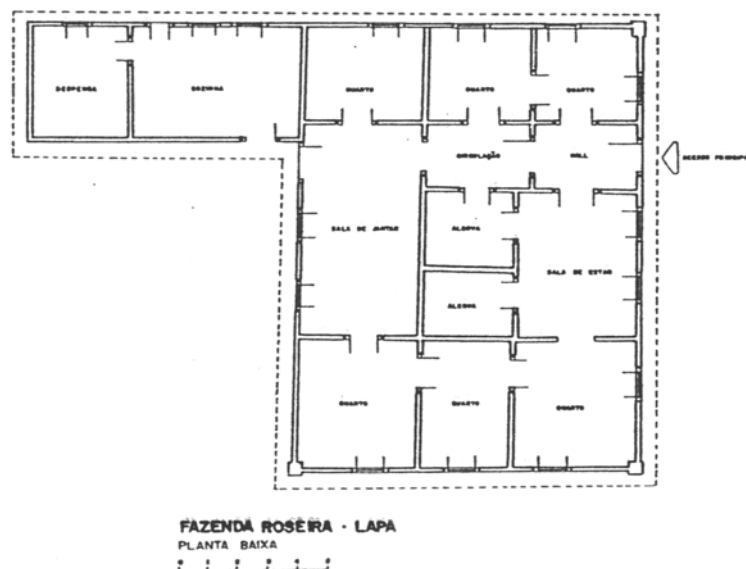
Planta baixa da Fazenda Roseira - Lapa
